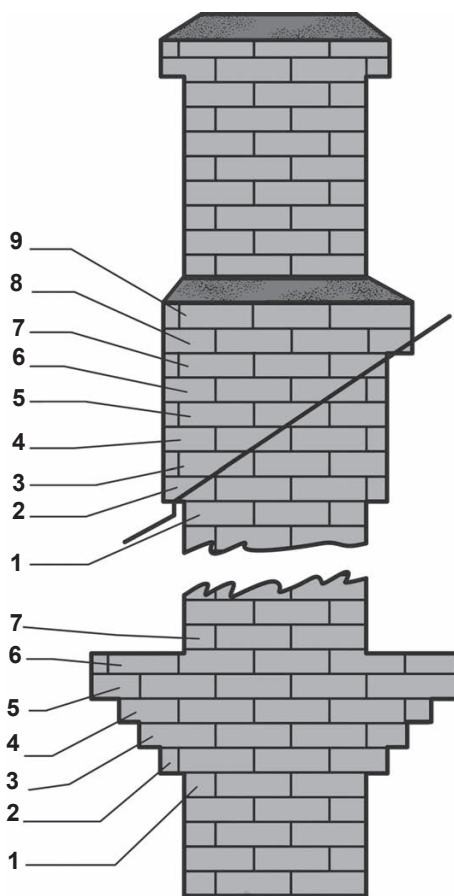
Кладка распушки и выдры — общий вид трубы
